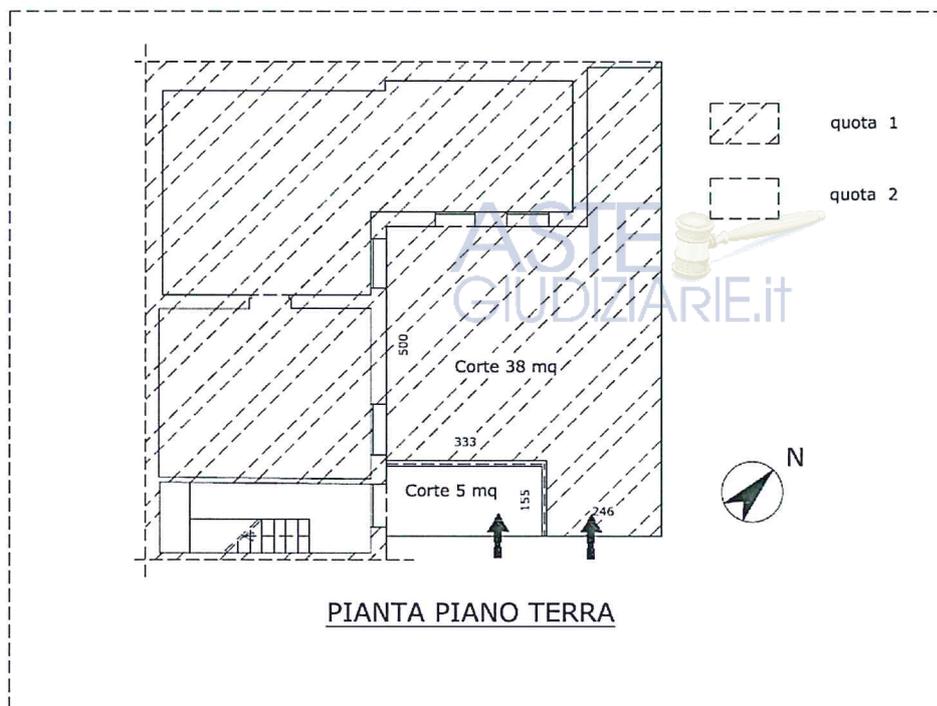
Schema divisione cortile fra quota 1 e quota 2 considerata demolizione corpo secondario
